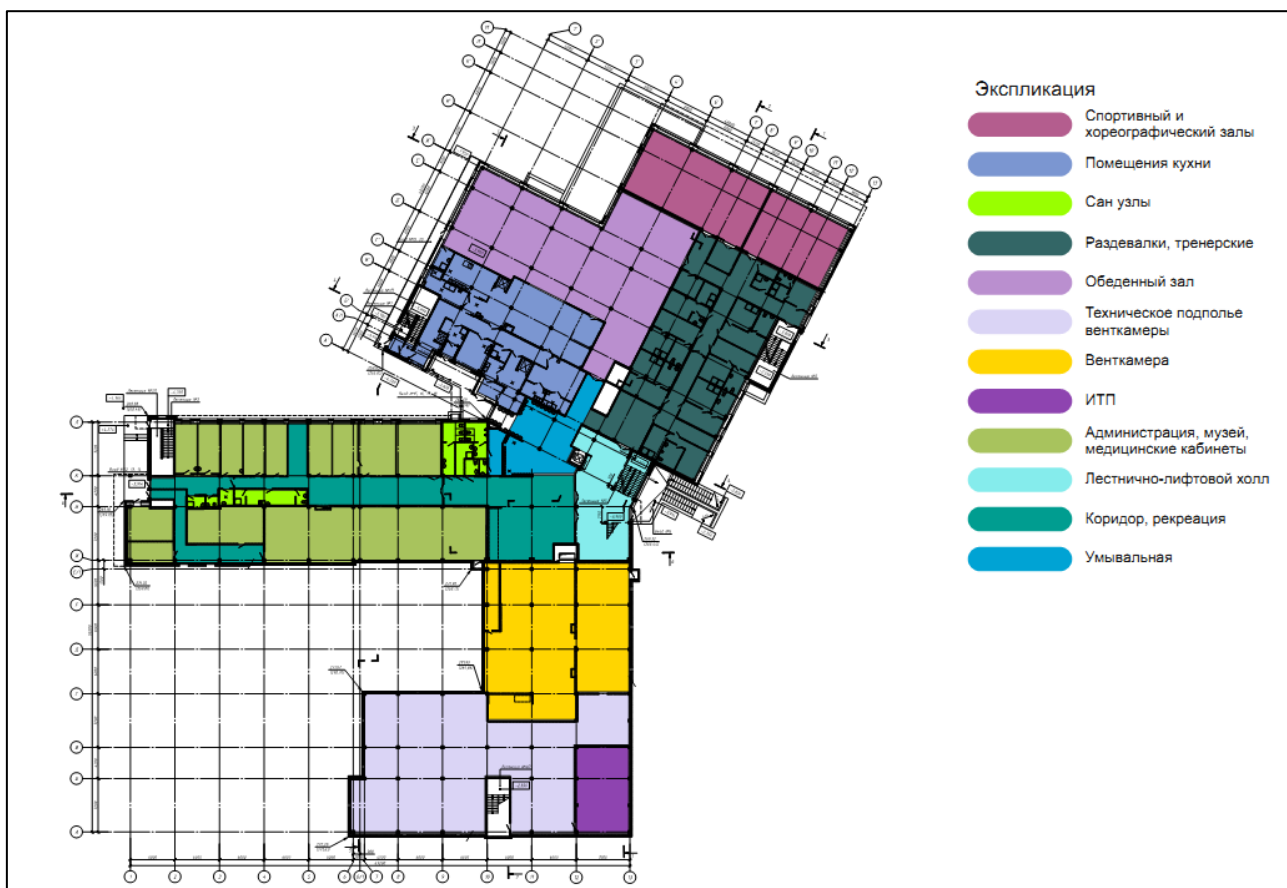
план размещения арендных площадей на 1 этаже
